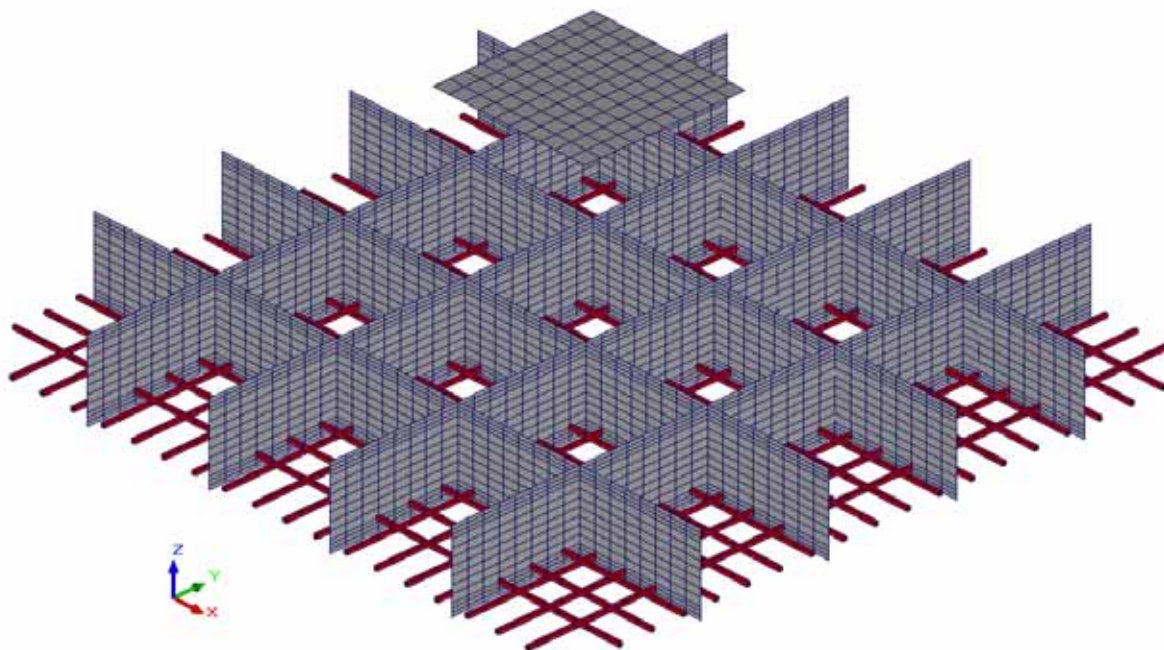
Расчётная схема 6 (PC6). Бетон условно не показан
